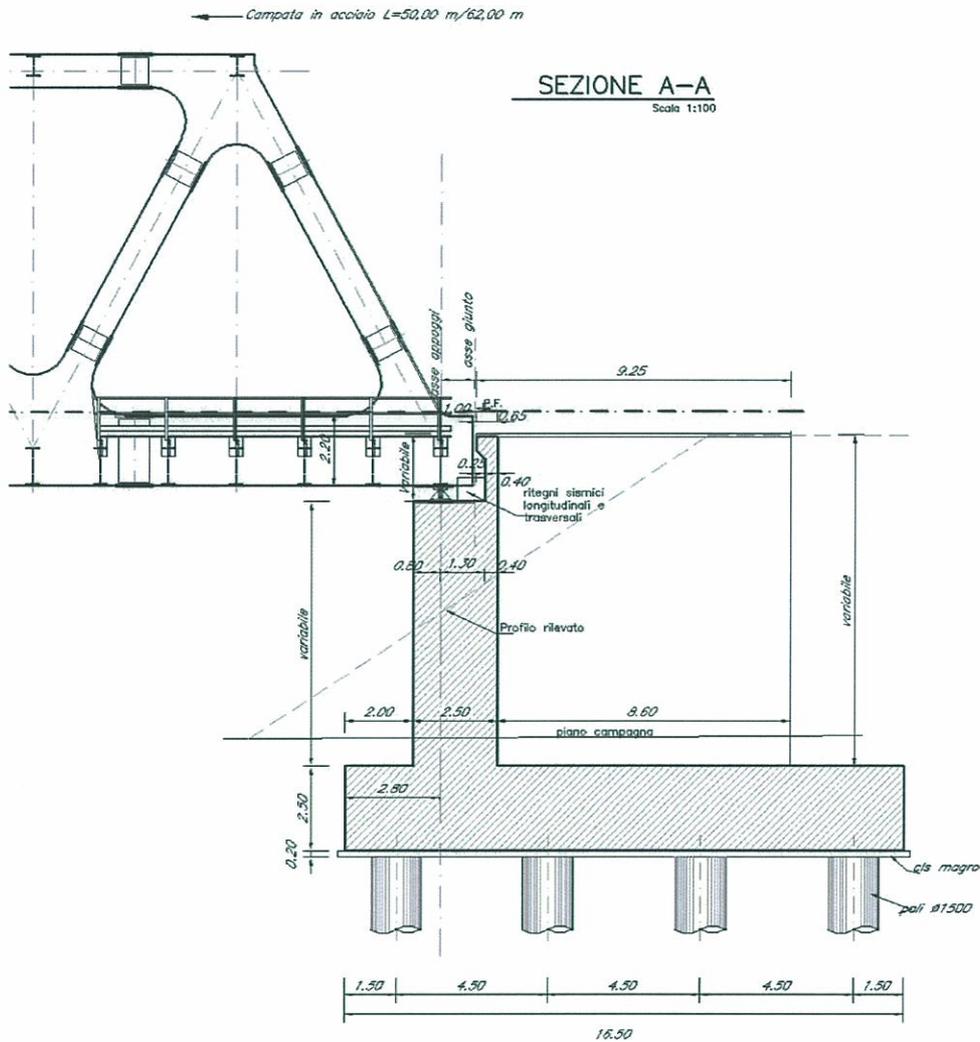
Sezione longitudinale della spalla tipo.
